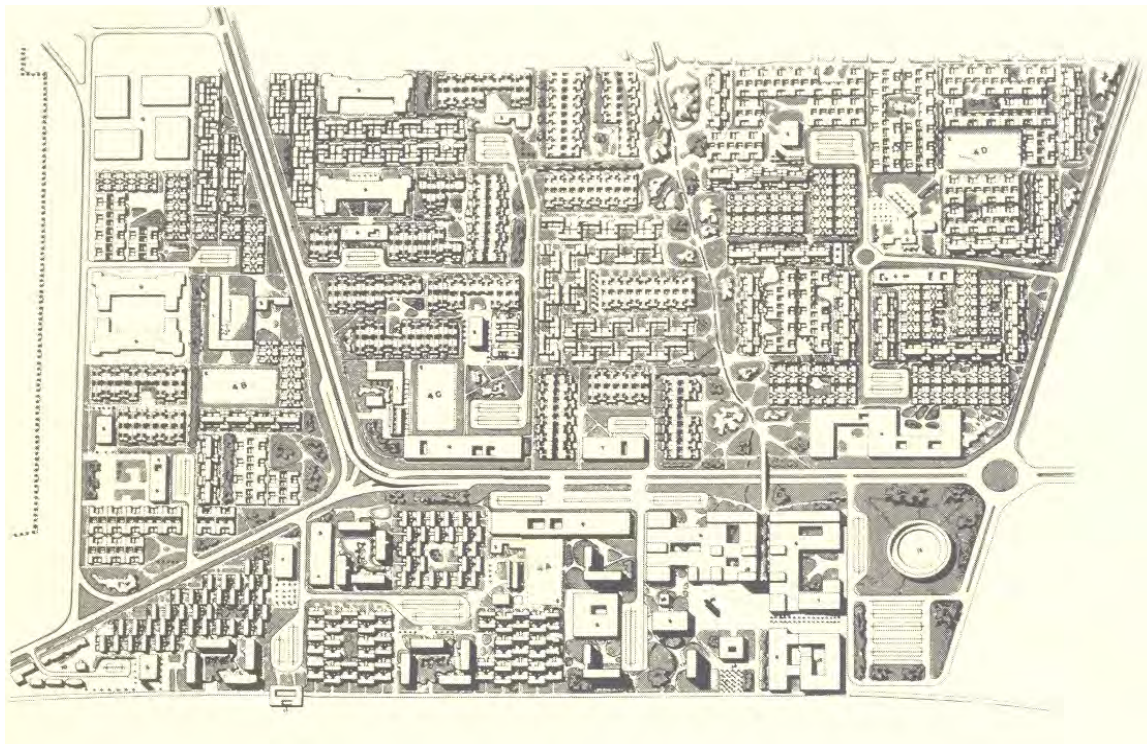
Plan Piloto de Chimbote. El Conjunto.
